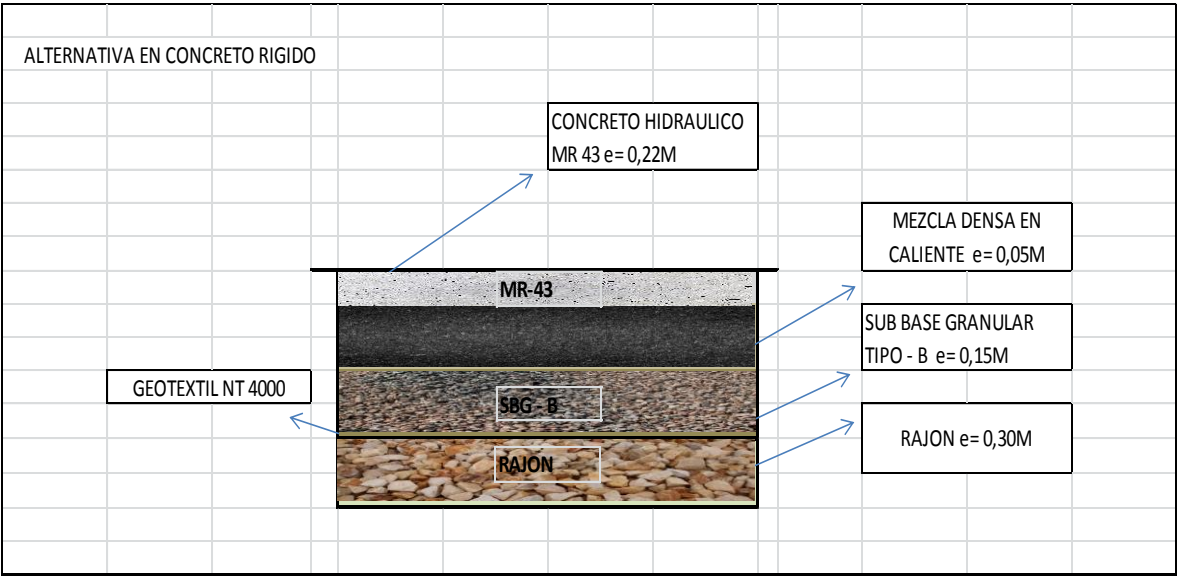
Sección típica de pavimento rígido. Fuente: Elaboración propia.
